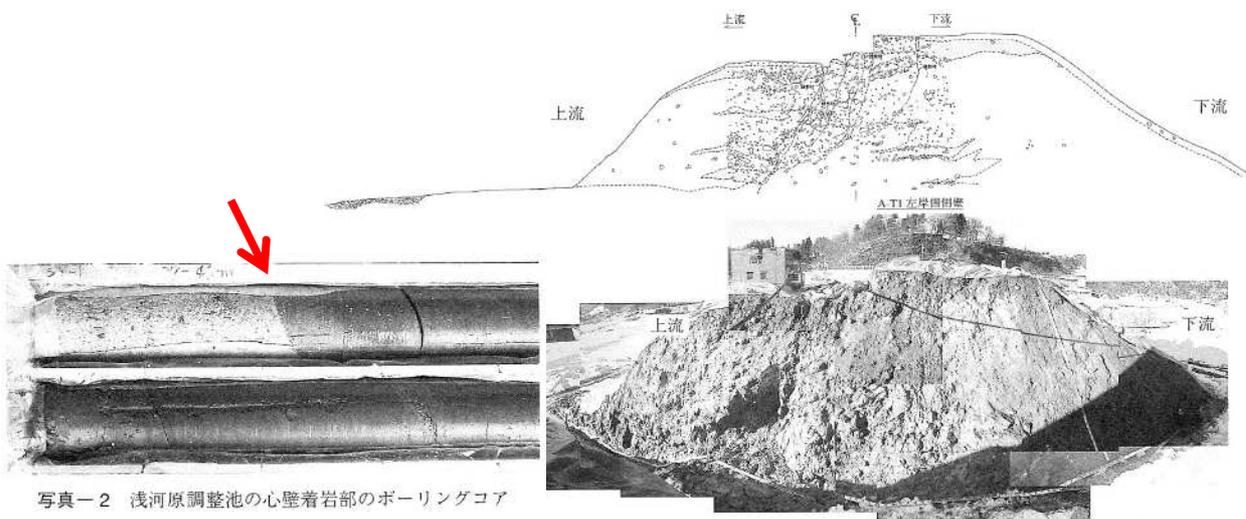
浅河原調整池の心壁着岩部のボーリングコア
